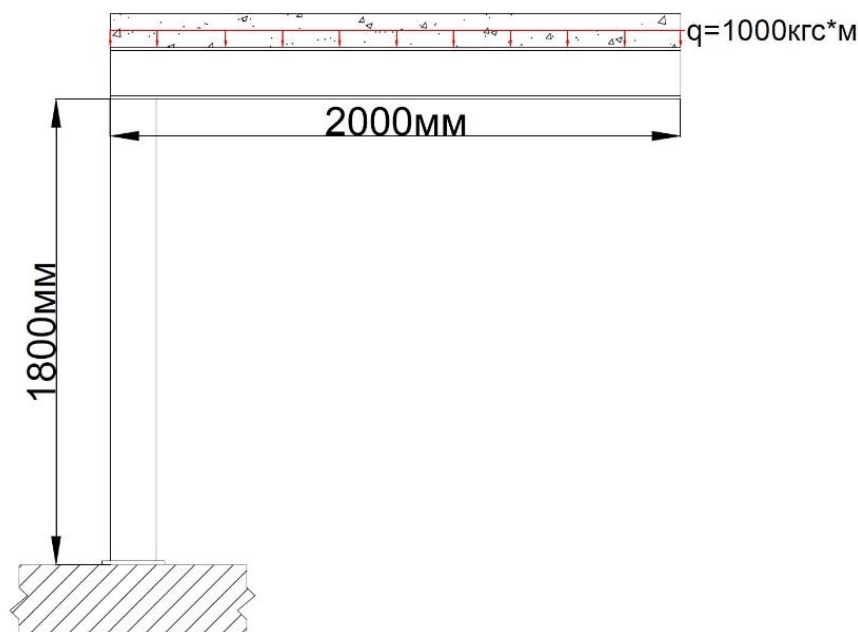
Конструкция площадки лестницы с одной опорой
